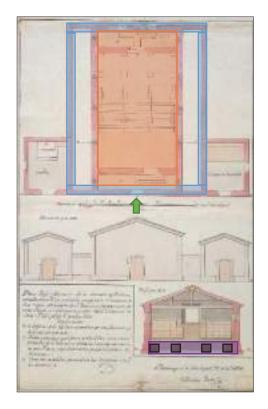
Plano, perfil y elevación de un almacén de pólvora en Santo Domingo. Fuente: Archivo de indias
